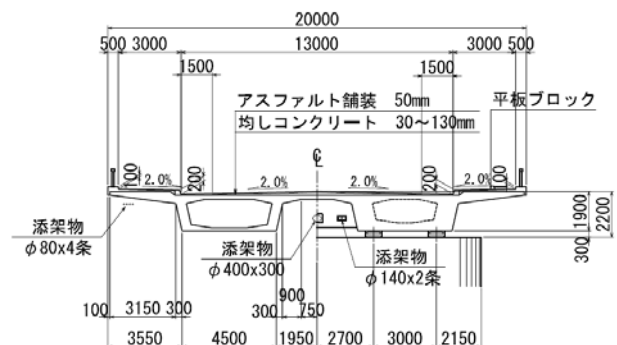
主桁断面図 (2 室箱桁, 非分離構造)
